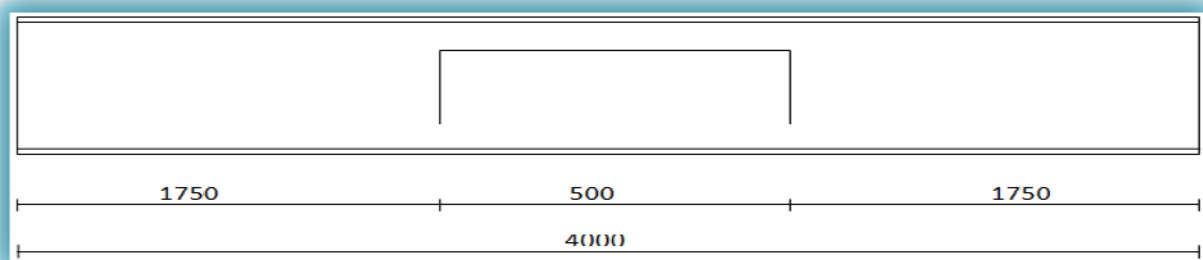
Vue longitudinale d'une poutre à ouverture d'âme
